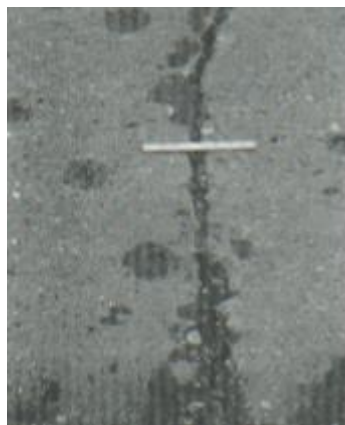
Grietas lineales de severidad media en losa de concreto reforzado.
